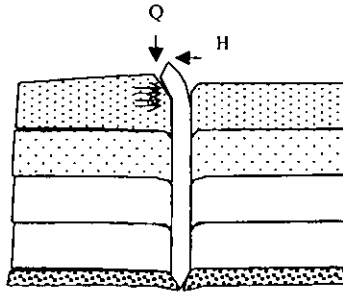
PILA O PILOTE CON CARGA HORIZONTAL.
